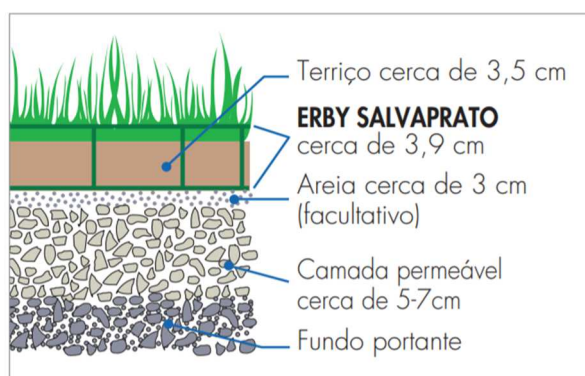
Estrutura de pavimento com grelhas de enlramento – exemplo 2 (Salvaprado).
